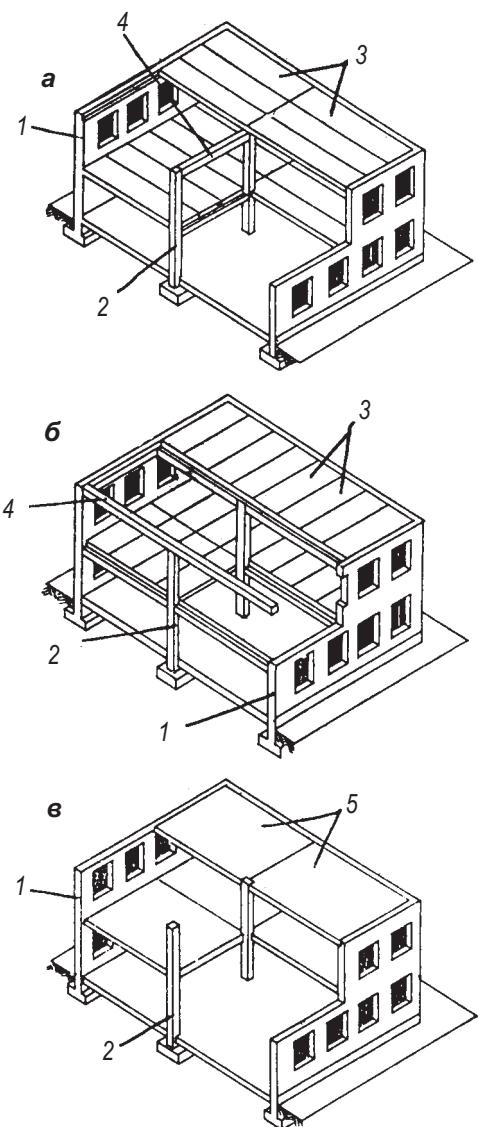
Конструктивні схеми будівель з неповними каркасами:
